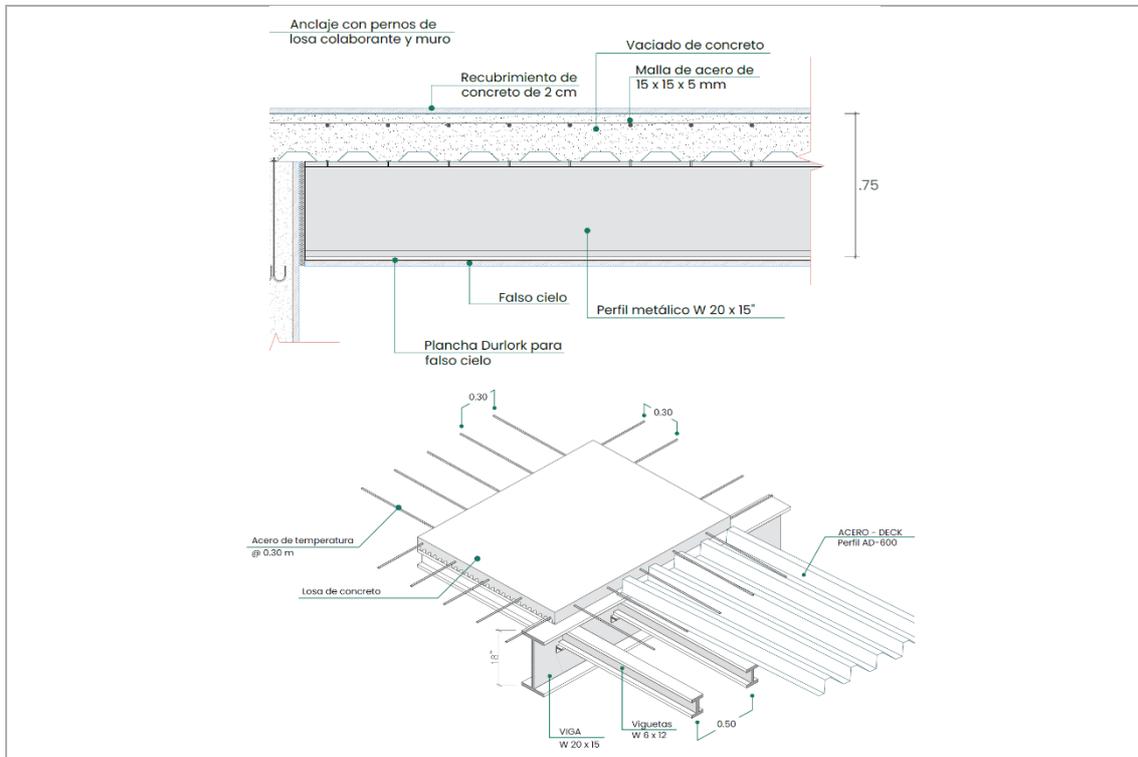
Losa Colaborante propuesta en Zona Complementaria – Bloque G.
